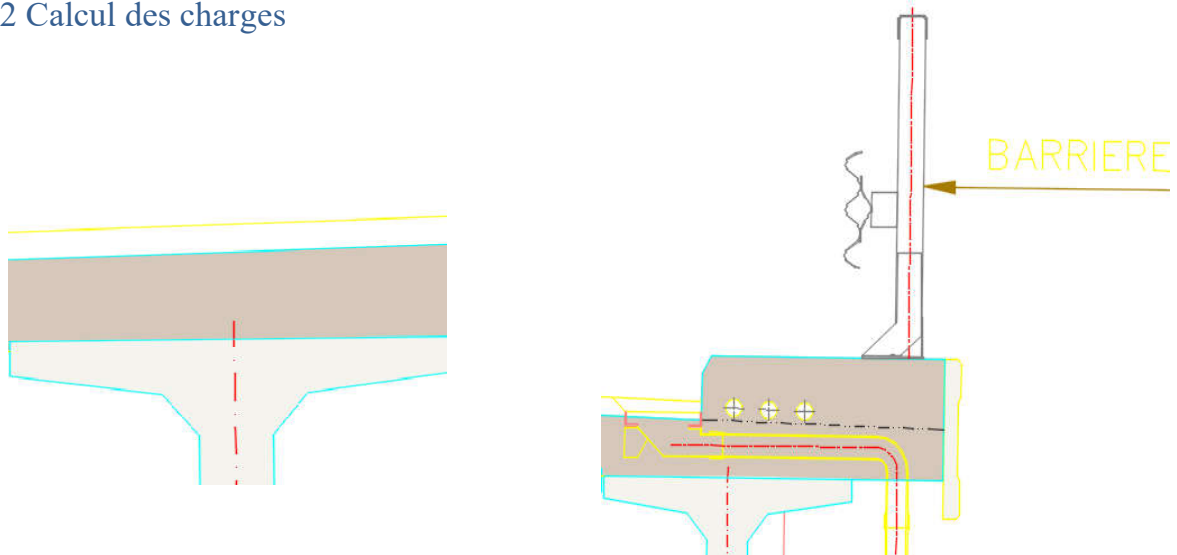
Poutre intermédiaire Figure 2 : Poutre de rive
